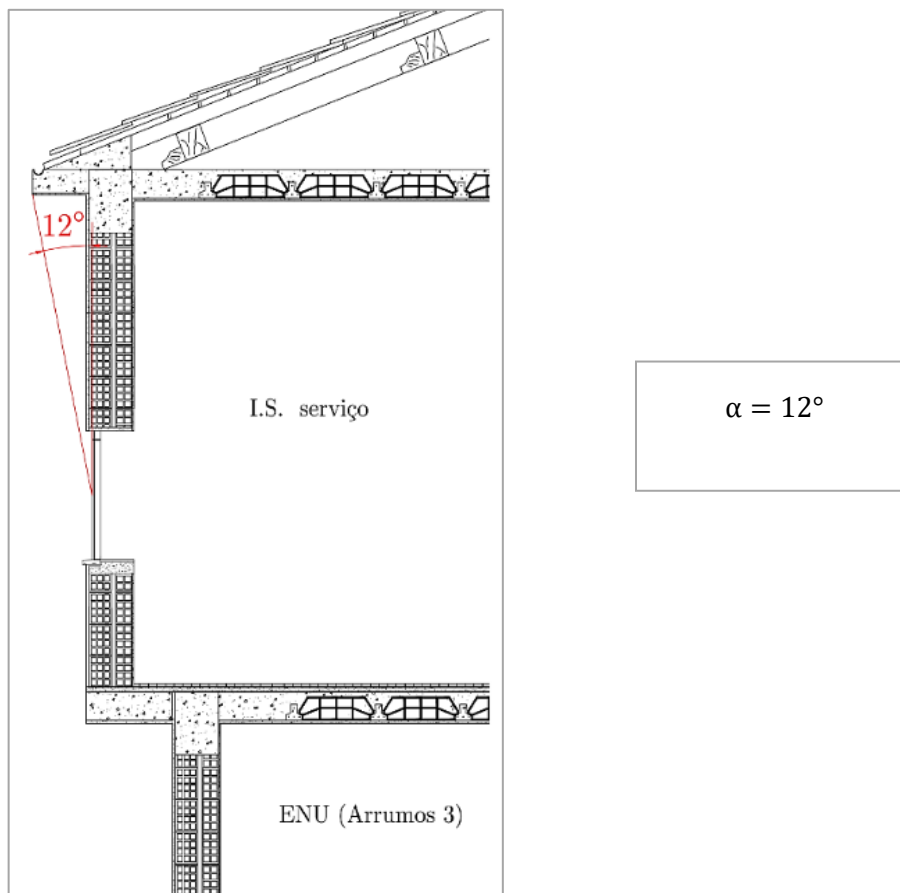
Esquema para a determinação do ângulo α da obstrução horizontal do envidraçado da I.S. serviço, orientado para SO.
